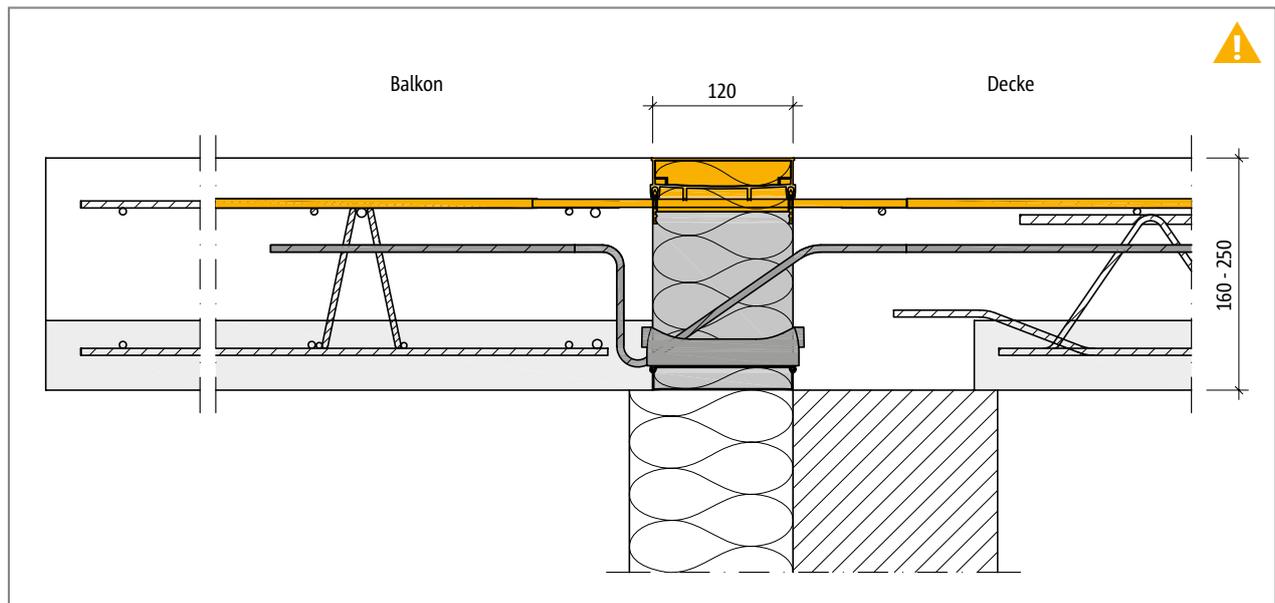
Schöck Isokorb® Typ KFXT: Oberteil zur Zugkraftübertragung erforderlich
